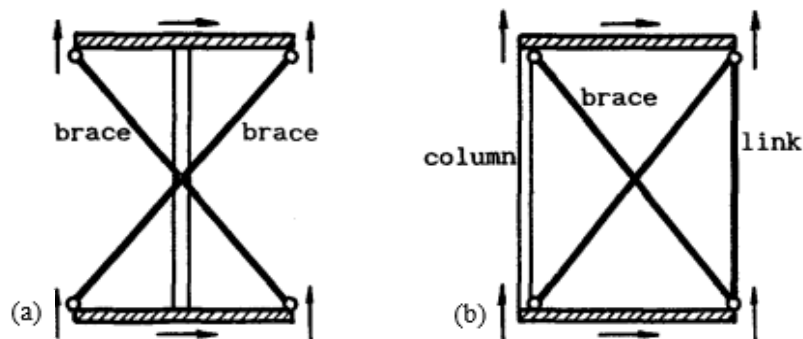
(a) Modulo de columna ancha arriostrada; (b) Modulo de pórtico reforzada.
